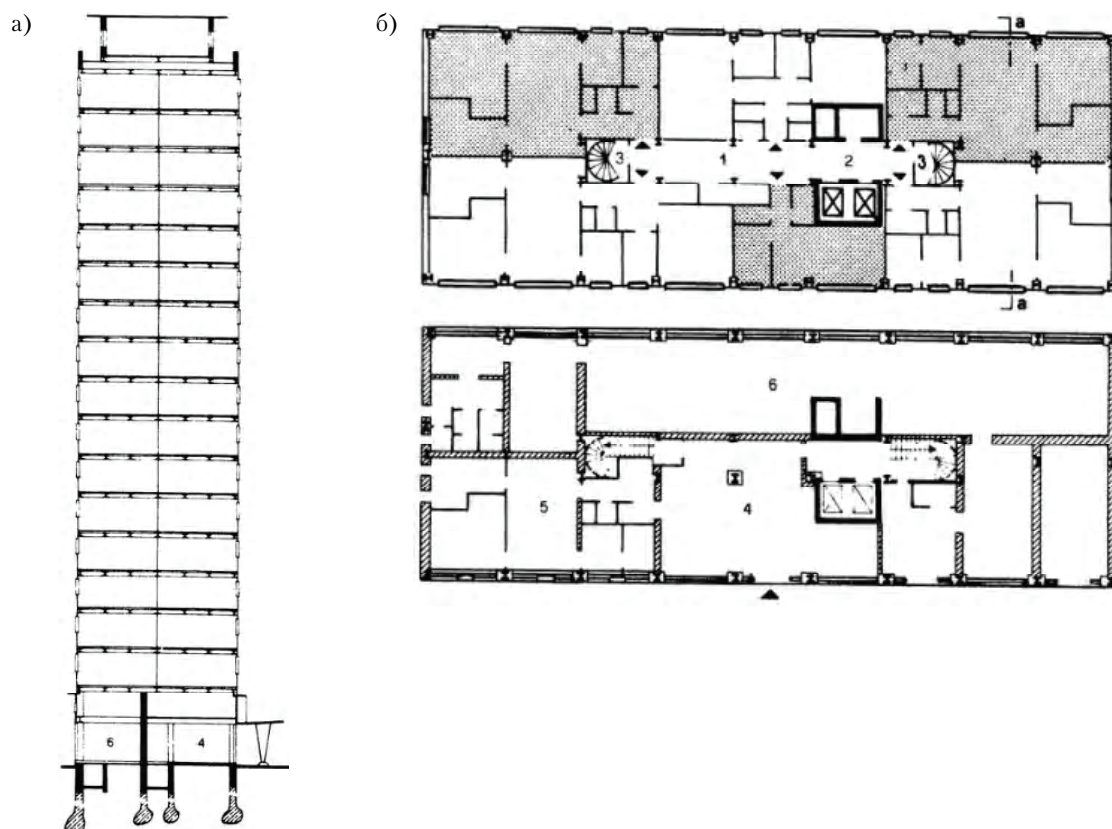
Схема 16-ти этажного здания: а) поперечный разрез; б) план первого и типовой этажей.
